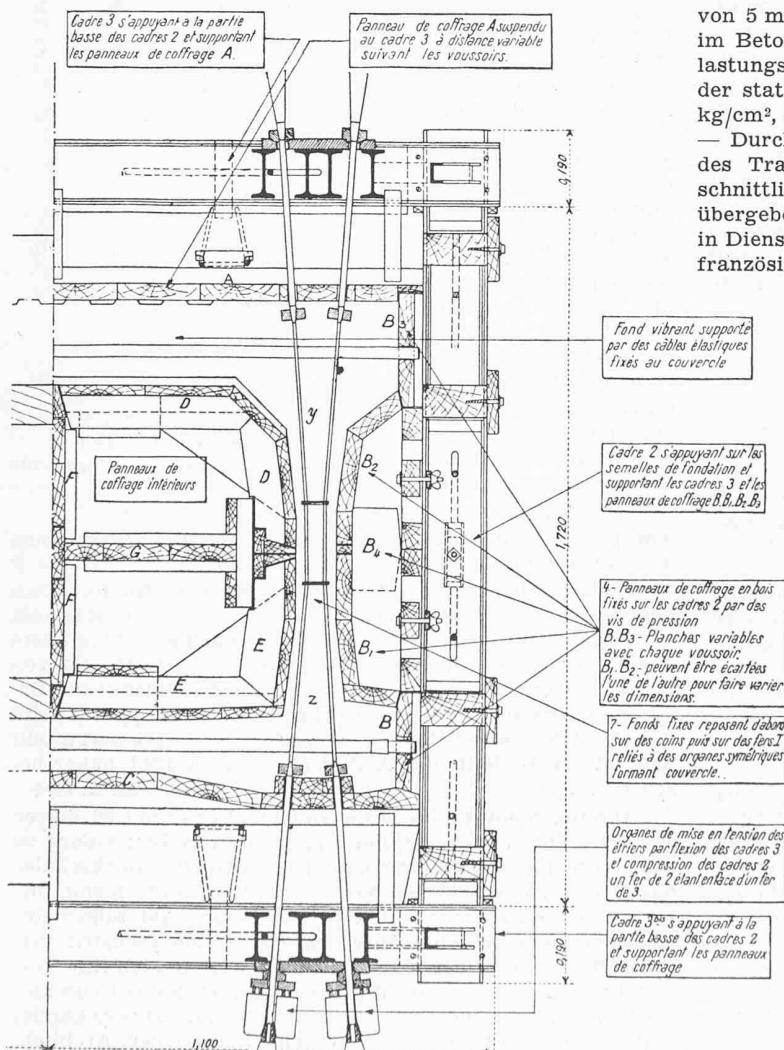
Grundriss eines Schalungs-Elementes für die Kastenprofilbalken-Teilstücke mit den Einrichtungen für das Vorspannen der Bügel. — 1:18
